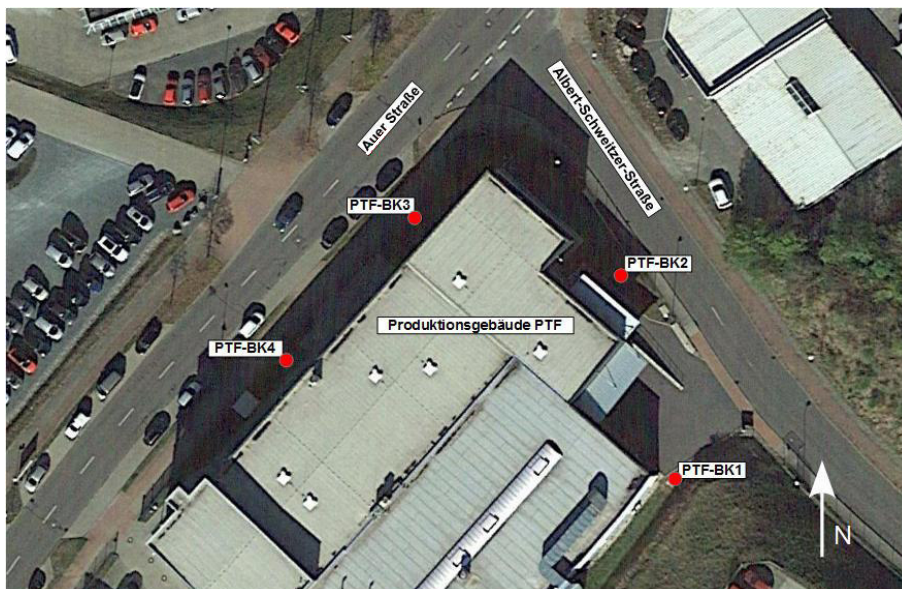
Lageplan PTF Pfüller GmbH & Co. KG.
